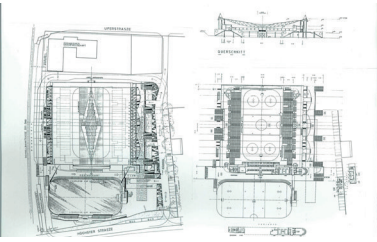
Grundrisse und Schnitte der Eissporthalle in Dornbirn
